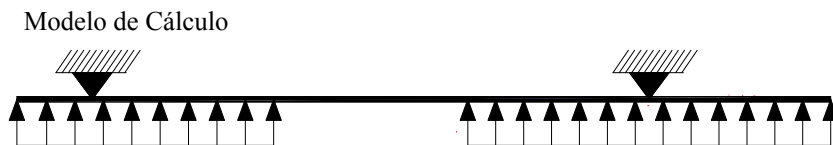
Zapata Excéntrica con Viga Riostra. Modelo Cimiento Rígido.
